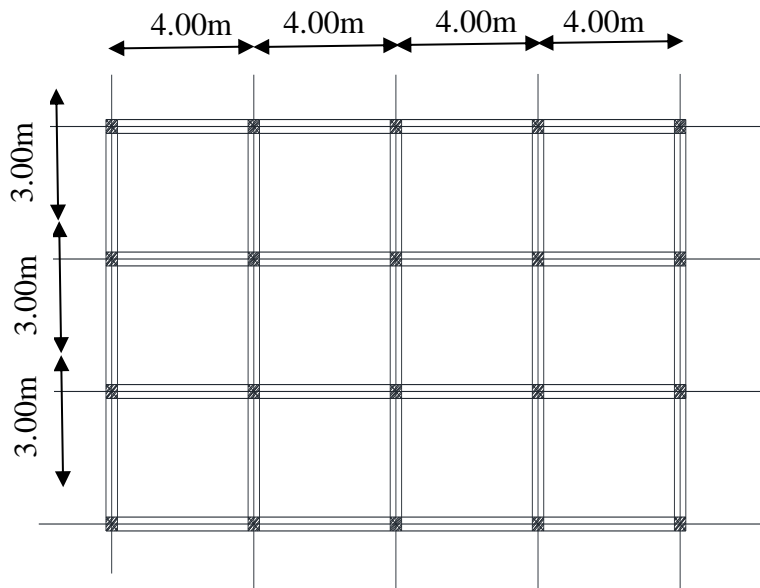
Plan pour les deux variantes (paramètre 4)
